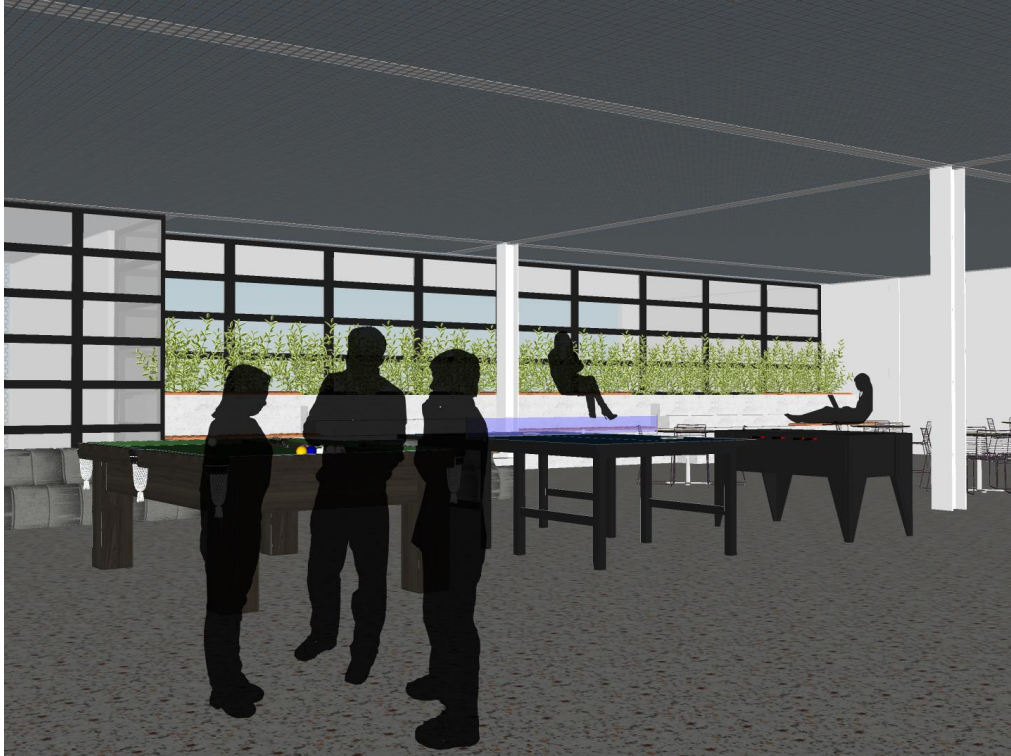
Vista espaço de lazer. Fonte: acervo da autora, 2021
